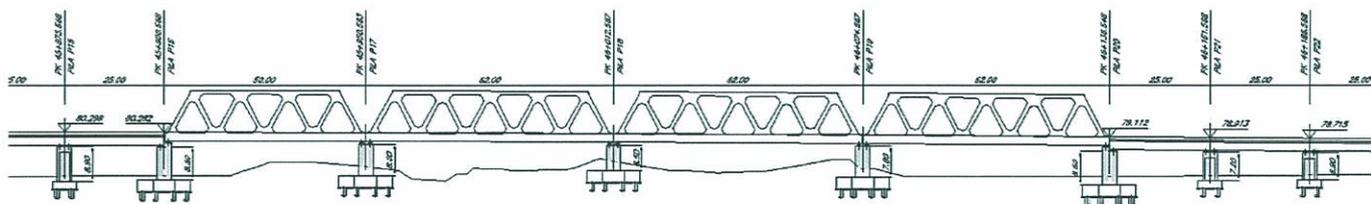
Prospetto dell'attraversamento del fiume Fosson e del canale Cerretta.
